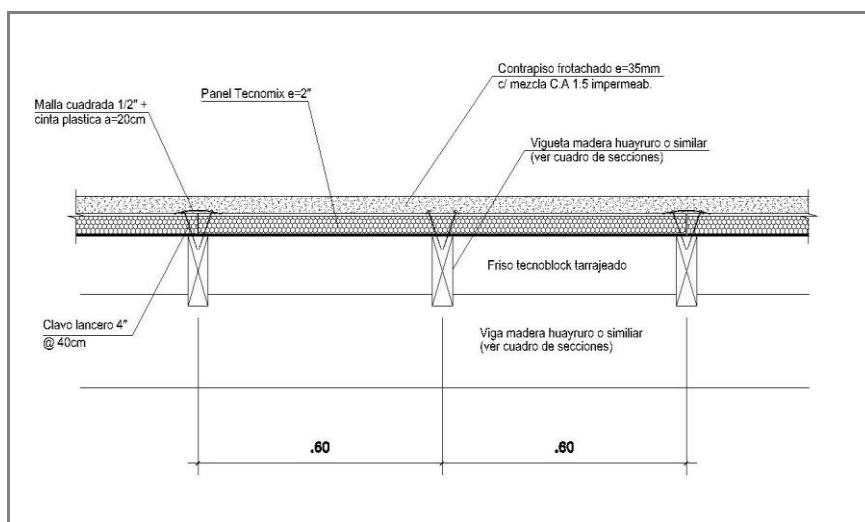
Detalle constructivo panel TECNOMIX con contrapiso impermeabilizado.
